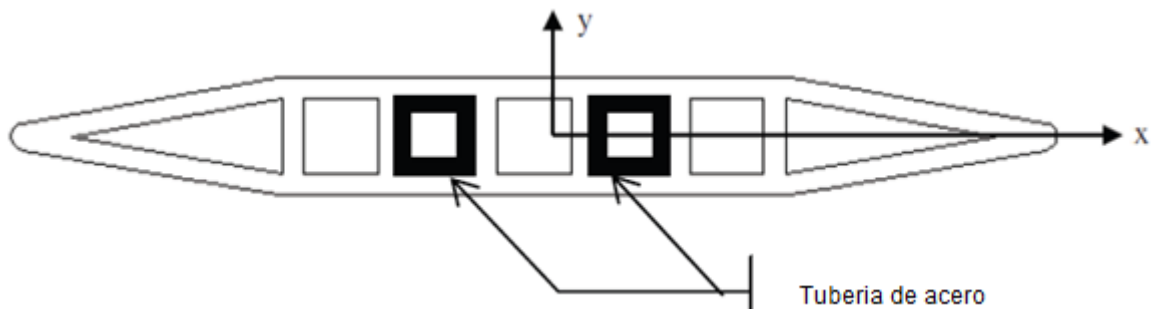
Sección diseñada de madera plástica reforzada con perfil tubular de acero, para ser utilizado en fachada de edificio. Fuente: (41)
